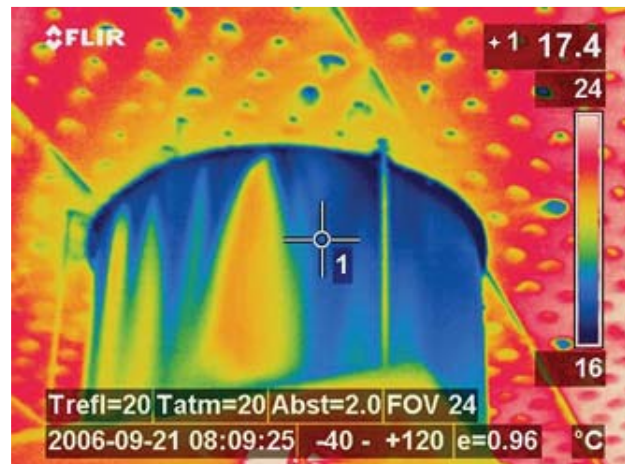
und 24: Frischluft wird unmittelbar wieder abgesaugt. Die Wärmebildaufnahme verdeutlicht diesen Mangel.
